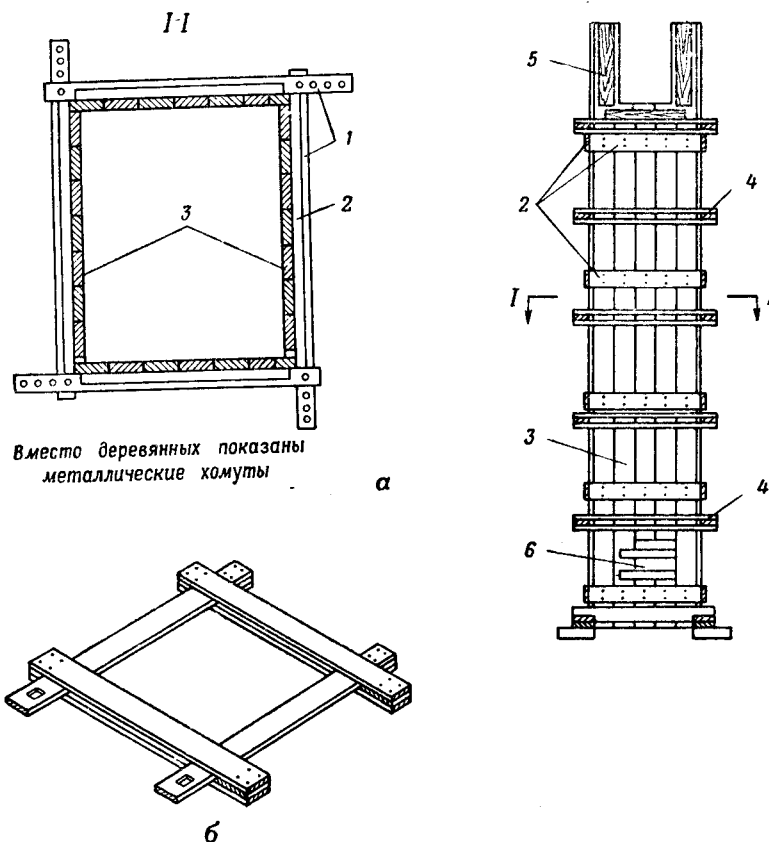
Деревянная опалубка для бетонирования тела опоры моста:
